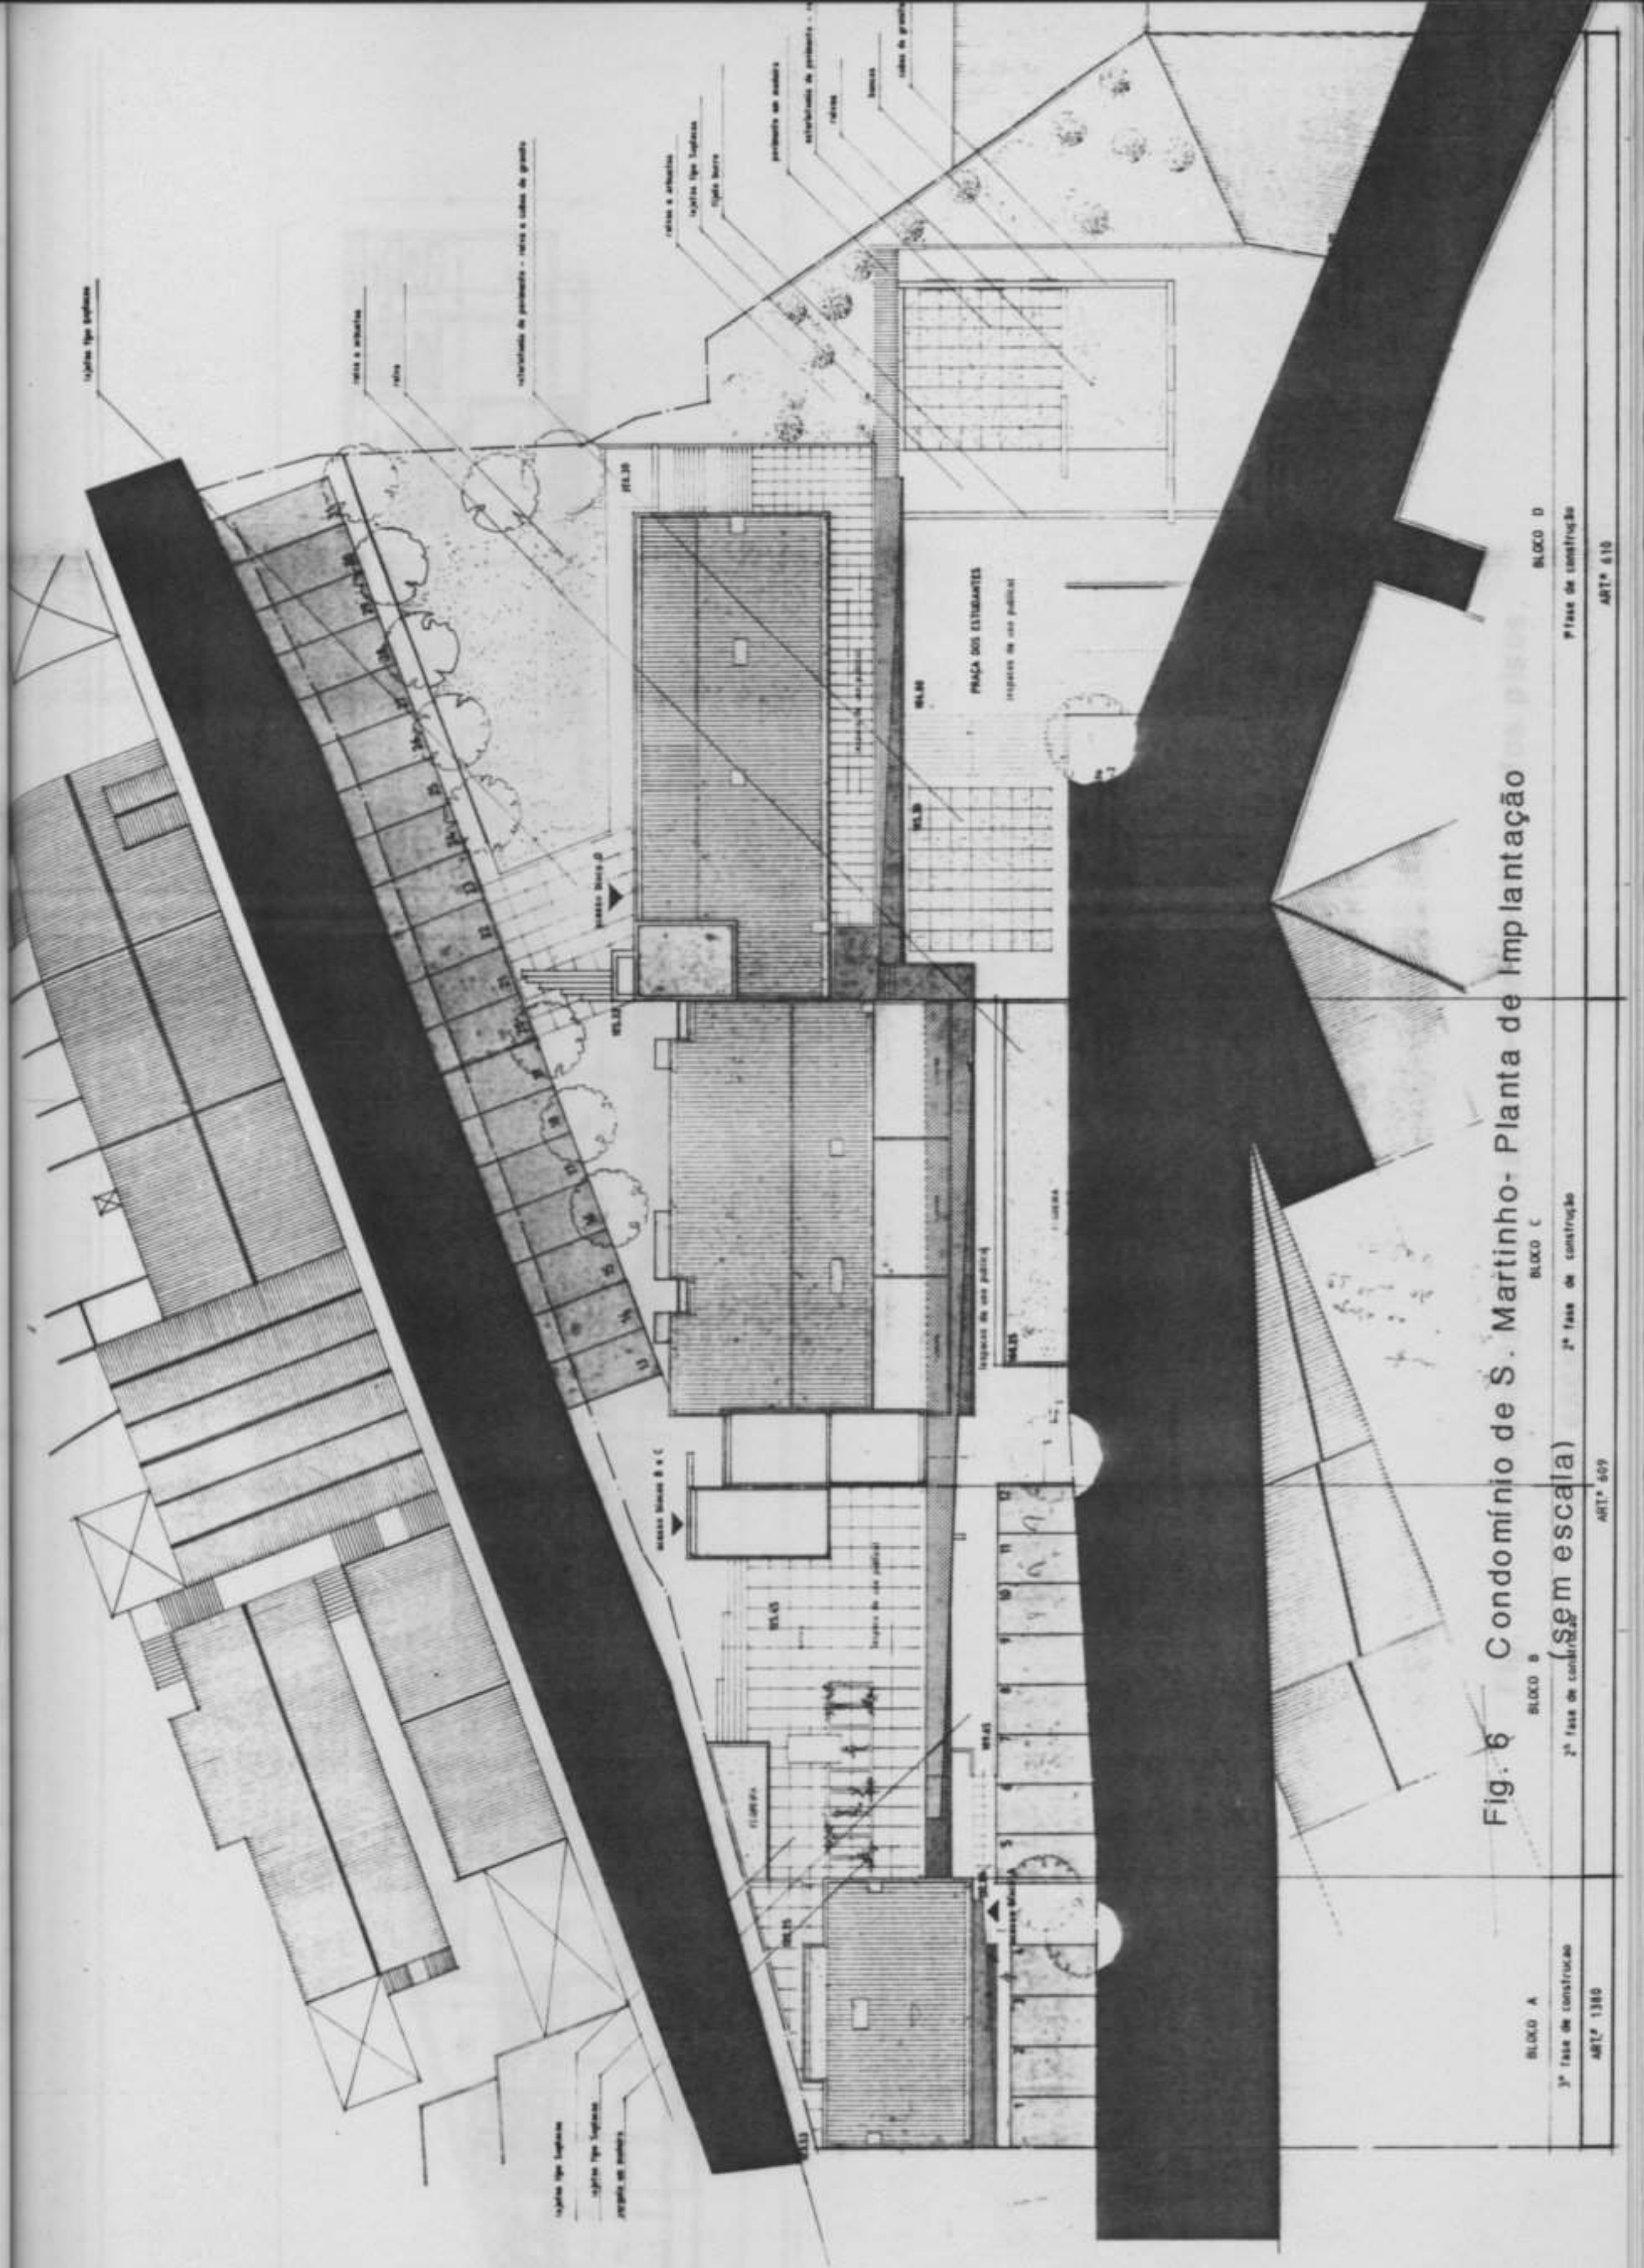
Condomínio de S. Martinho - Planta de Implantação
